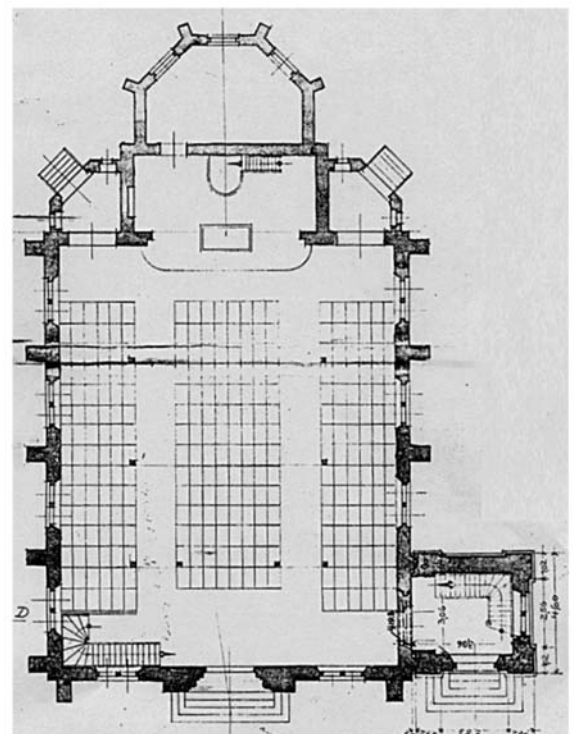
Grundriss zur Genehmigung des Turmneubaus, unsigniert (1933)
